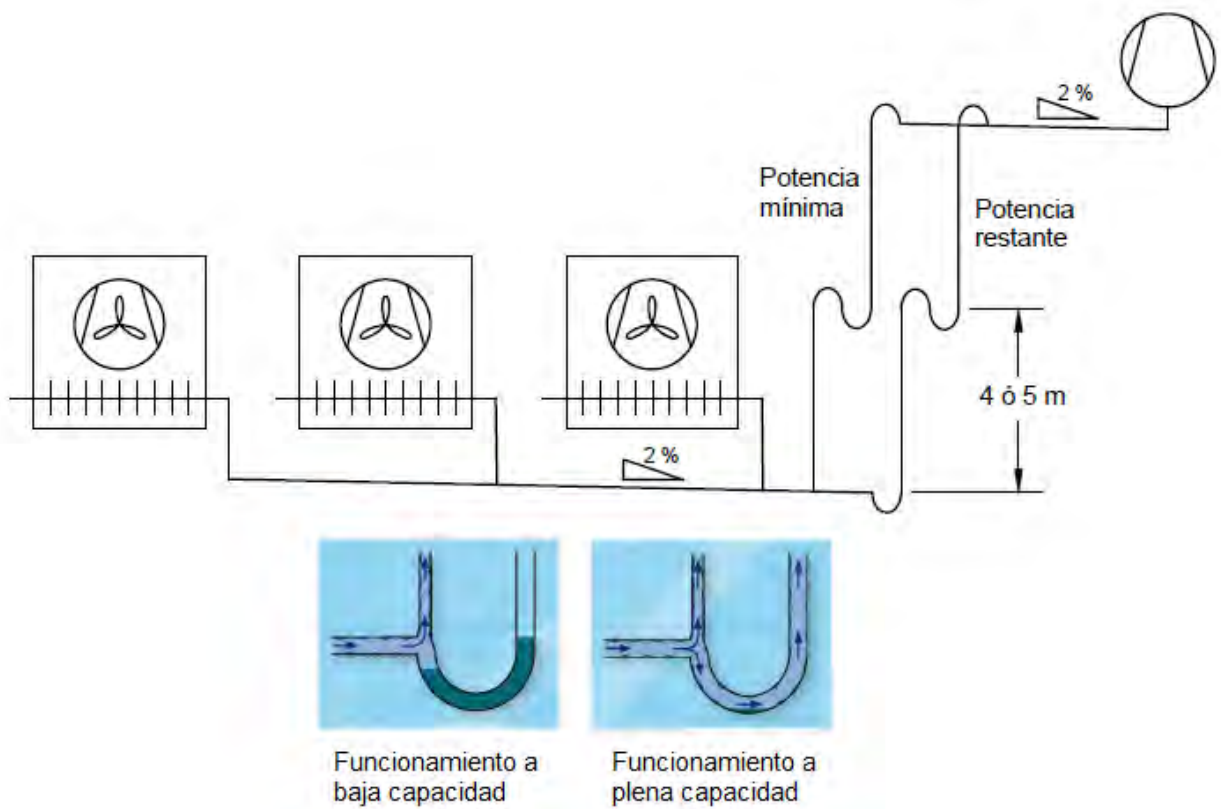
Detalle doble montante en tubería de aspiración.
